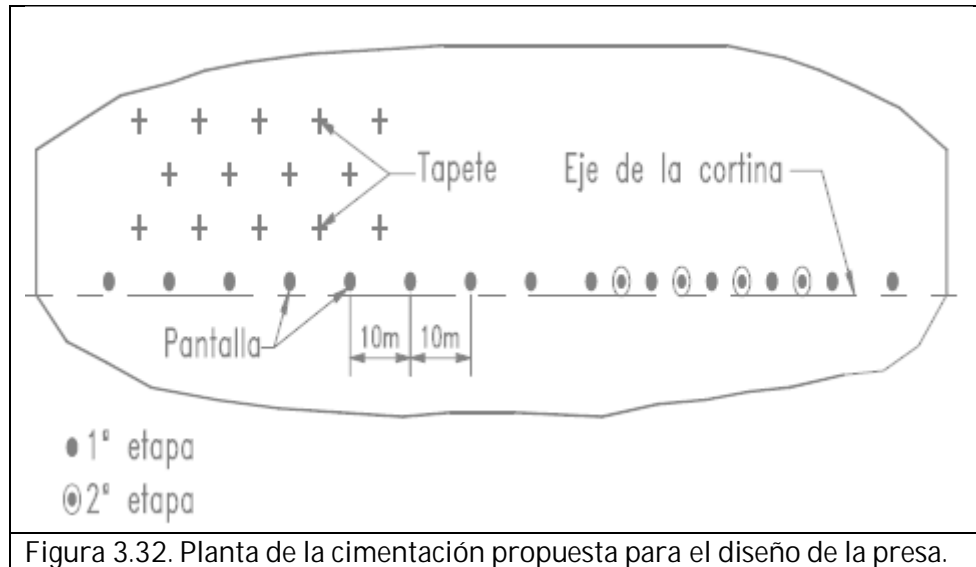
Planta de la cimentación propuesta para el diseño de la presa.
